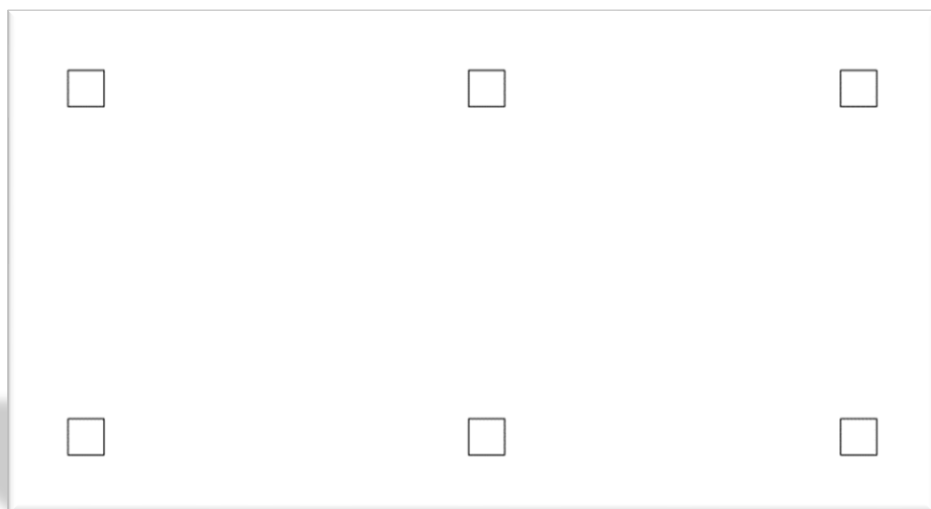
, Placa de cimentación visto en planta, elaboración propia
